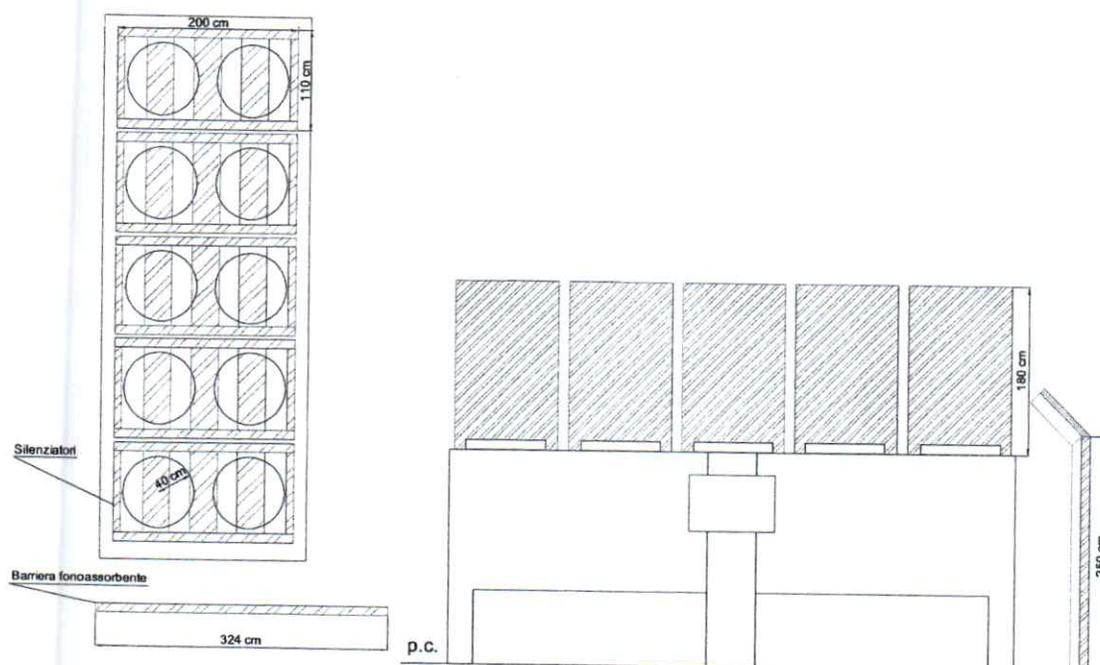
Stralcio di pianta e sezione della barriera e dei silenziatori
